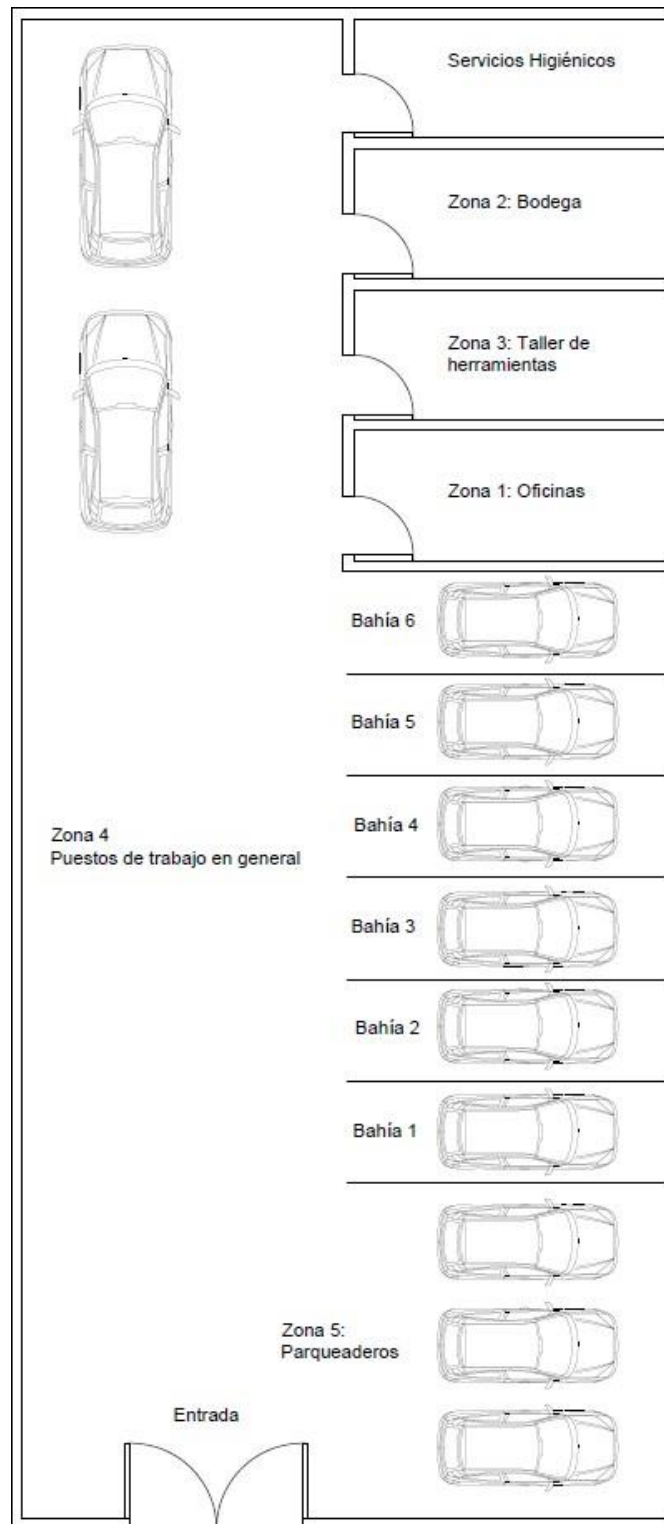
Plano zonal de la empresa Automecano del Sur
